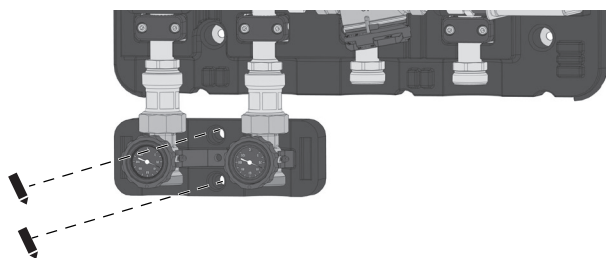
Bohrlocher Befestigungsschrauben markieren
